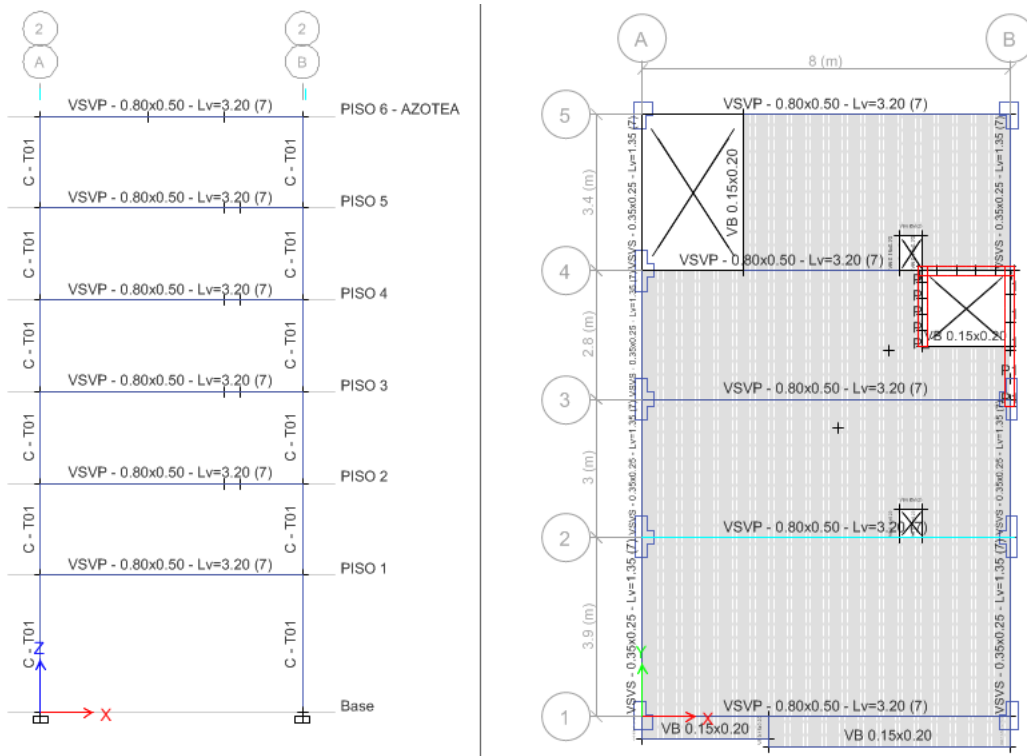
25 Vista en elevación y planta típica de la estructura del pórtico principal 2 - CASO N°07.
